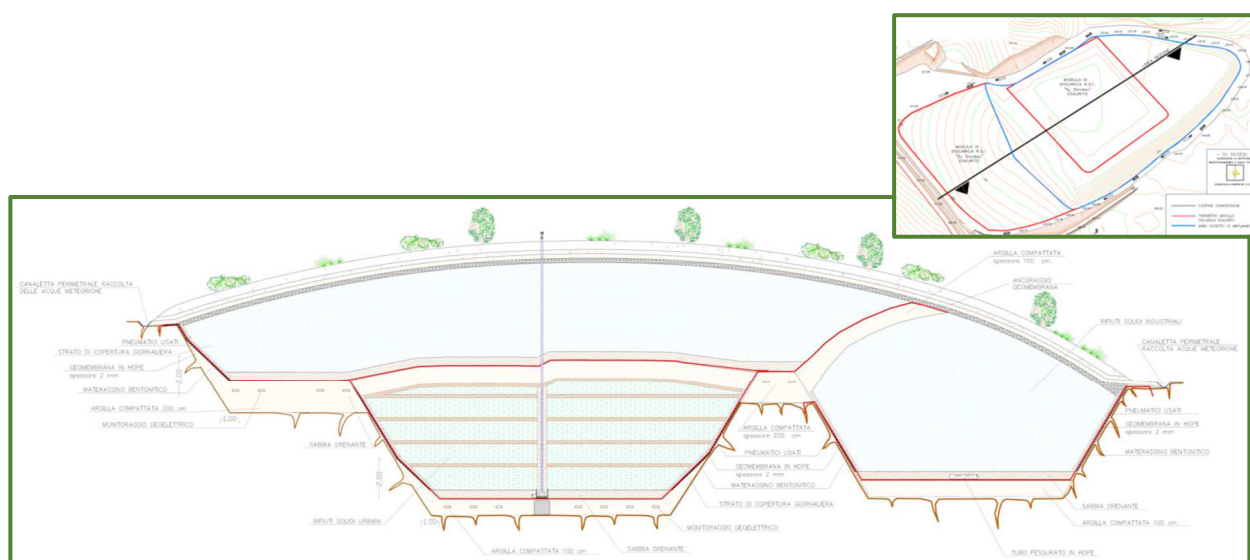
/II: Sezione-tipo modulo n. 6
